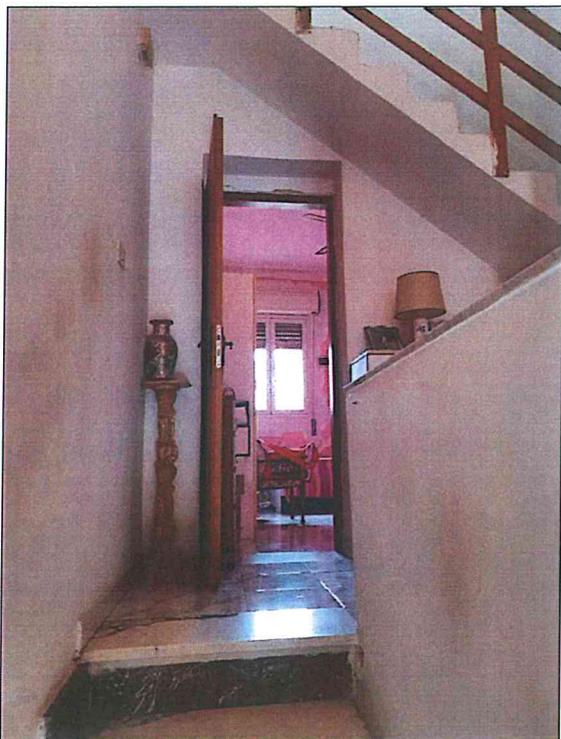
Foto del disimpegno servente la zona notte e della camera 2 con infisso in alluminio e climatizzazione. Sono presenti macchie d'umido in corrispondenza tra la parete e il solaio.
